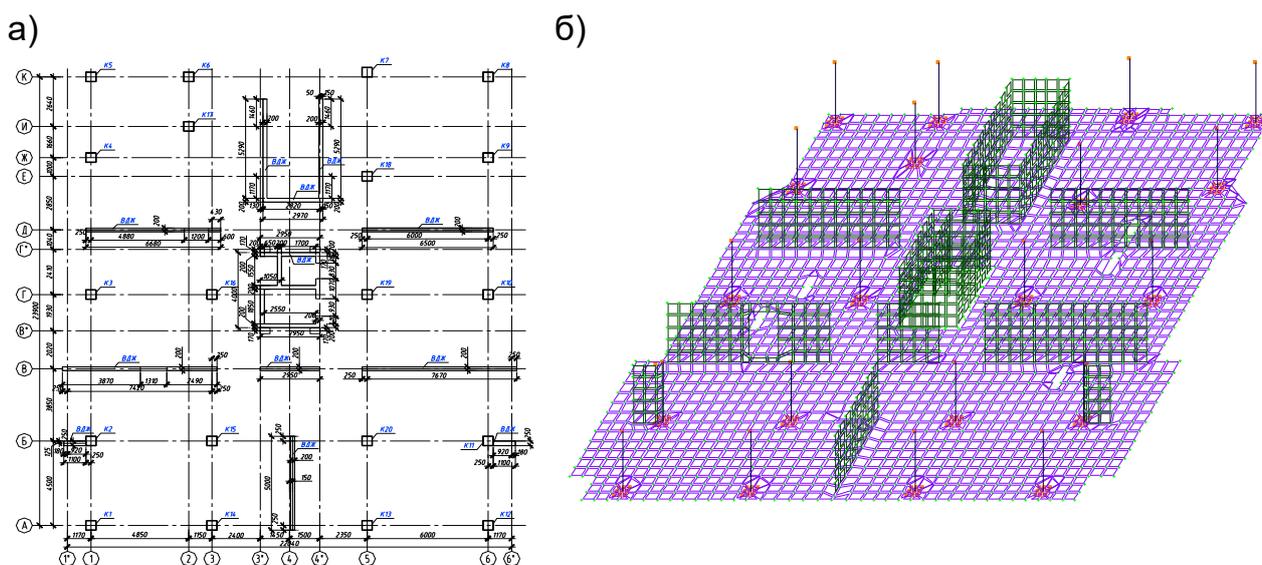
План здания по 1-му варианту (а) и разработанный фрагмент КЭМ
